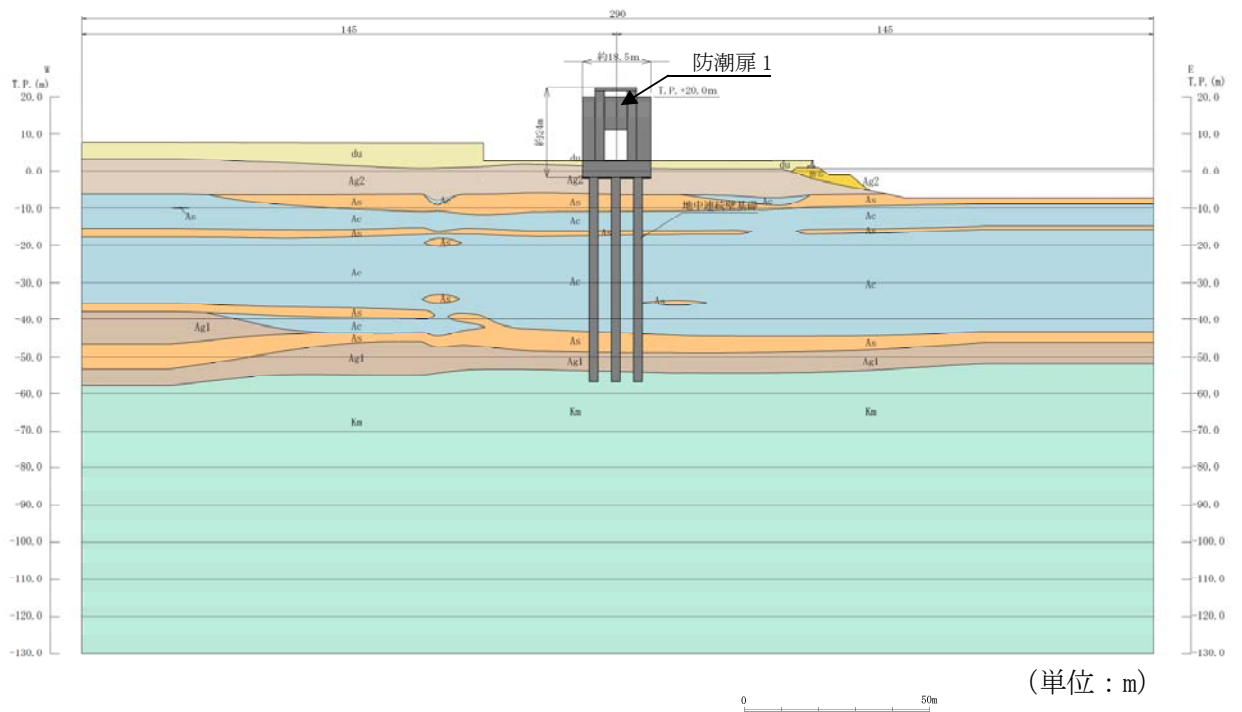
(8) 鉄筋コンクリート防潮壁 断面図(H-H断面)
